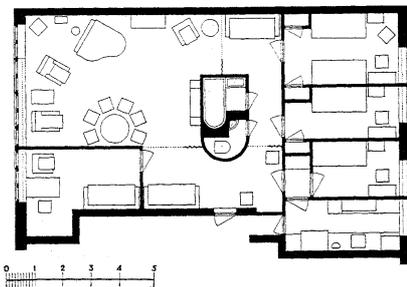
Sigurd Lewerentz: Grundriss der Mietwohnung 2.
